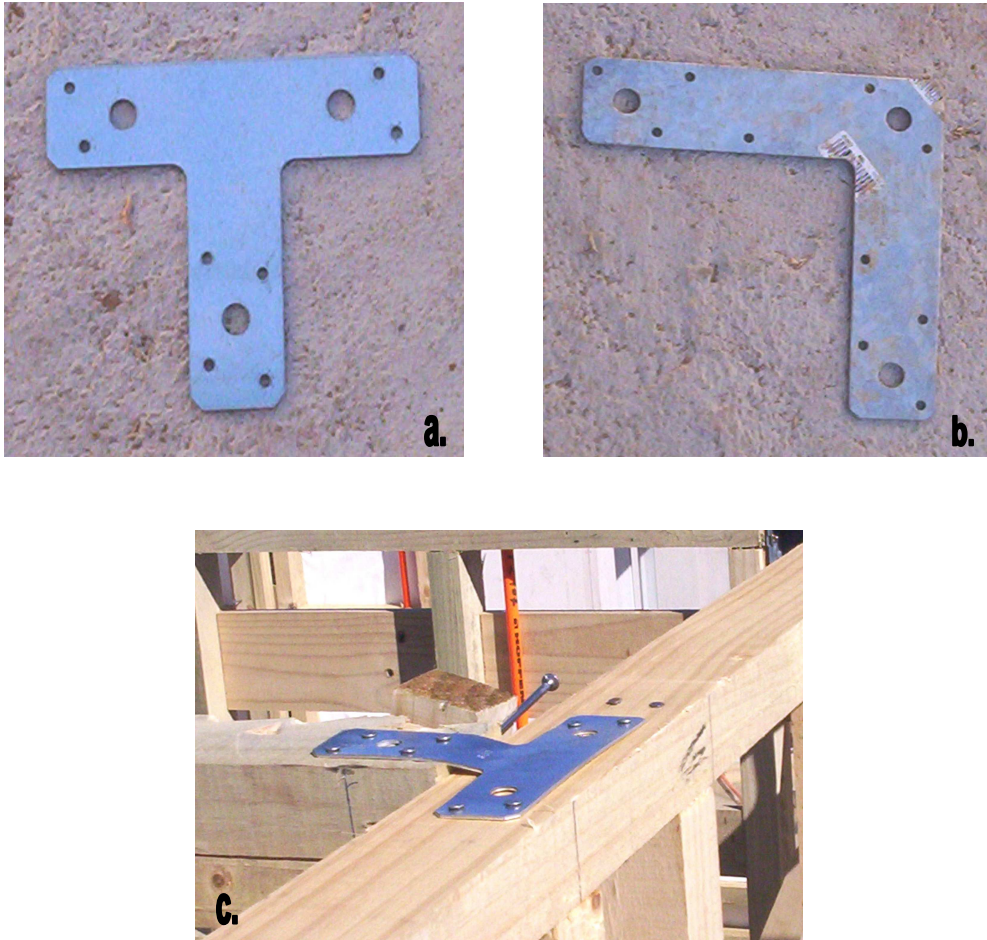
a. Conector metálico tipo "T" b. Conector metálico tipo "L" c. Encuentro entre tabiques
